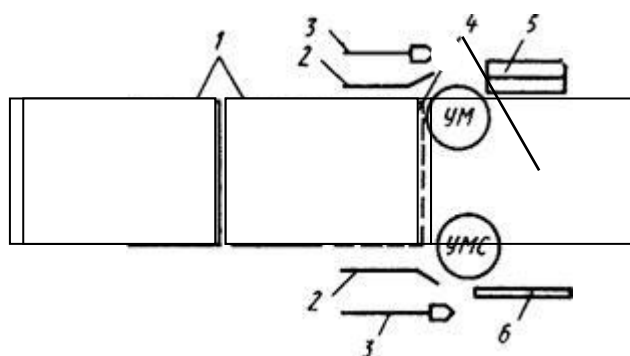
Схема организации рабочего места при монтаже ленточных фундаментных блоков:
